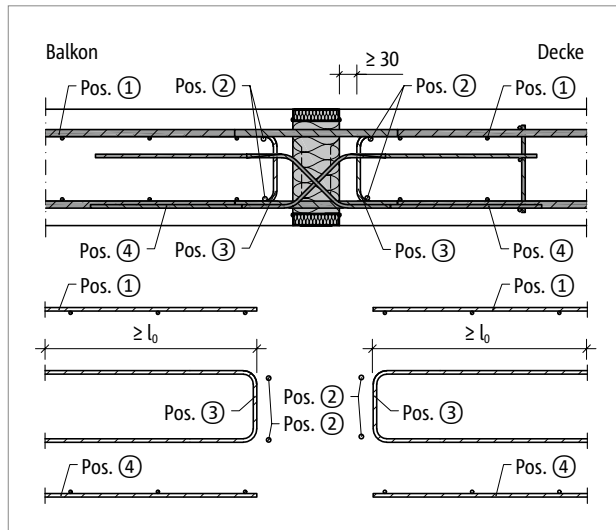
Schöck Isokorb® T Typ DP: Bauseitige Bewehrung
